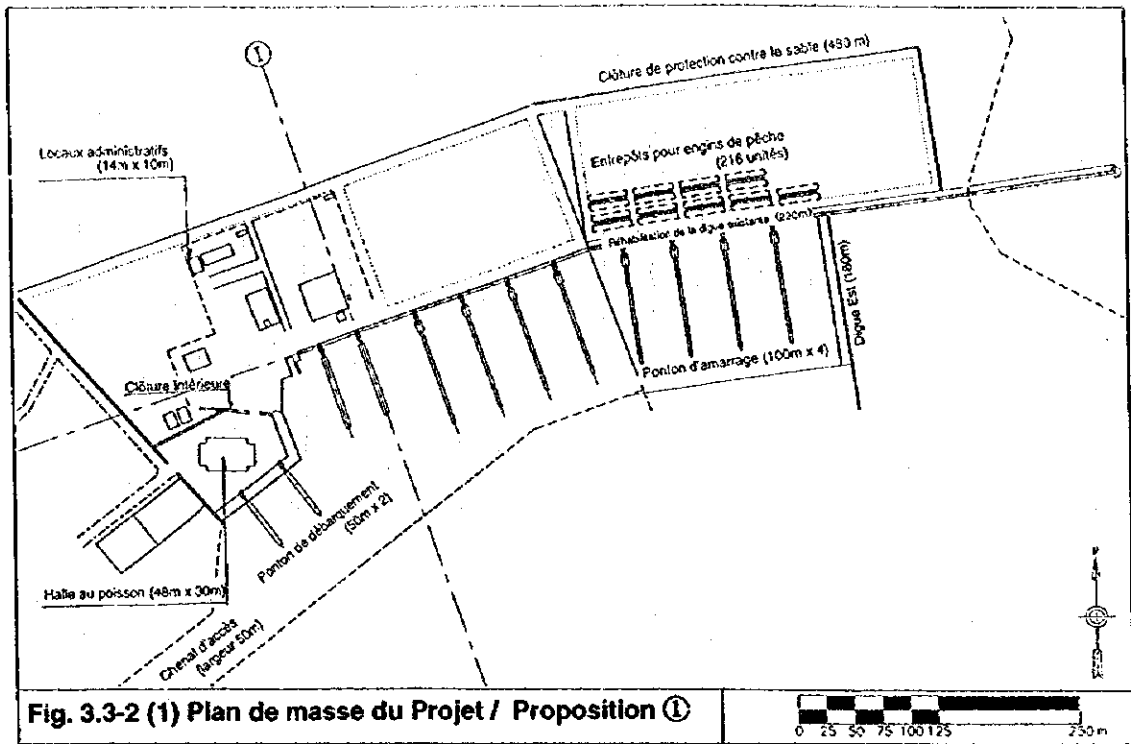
(1) Plan de masse du Projet / Proposition ①
